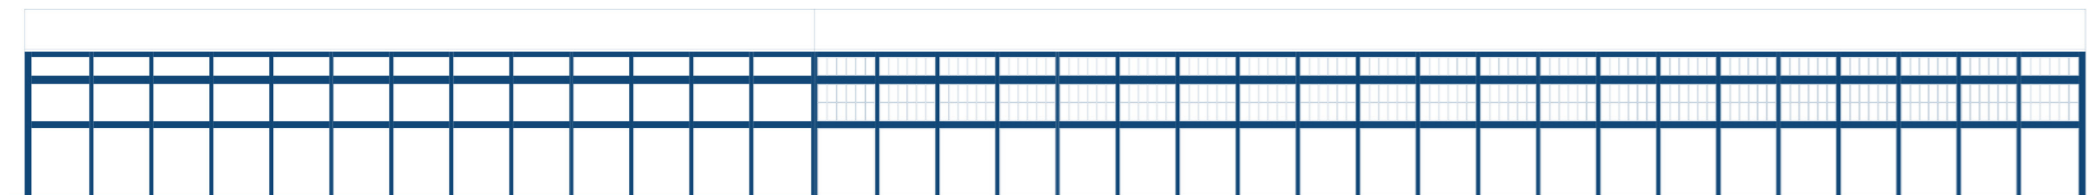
Evidenziazione della struttura portante a travi e pilastri in facciata.
